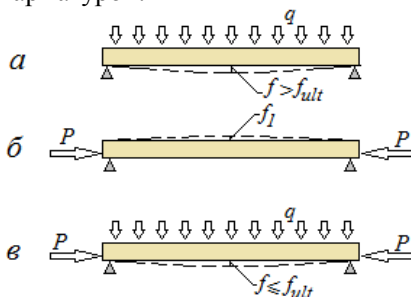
Механизм уменьшения прогиба железобетонной конструкции с предварительно напряженной арматурой: а - недопустимый прогиб конструкции f под нагрузкой q , б - выгиб предварительно напряженной конструкции f_1 при действии усилия обжатия P . в - допустимый прогиб конструкции с преднапряженной арматурой
